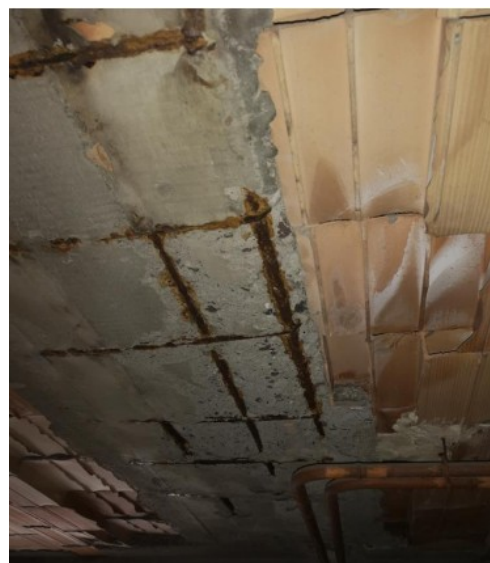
Ossidazione armatura trave Corpo E – piano interrato
